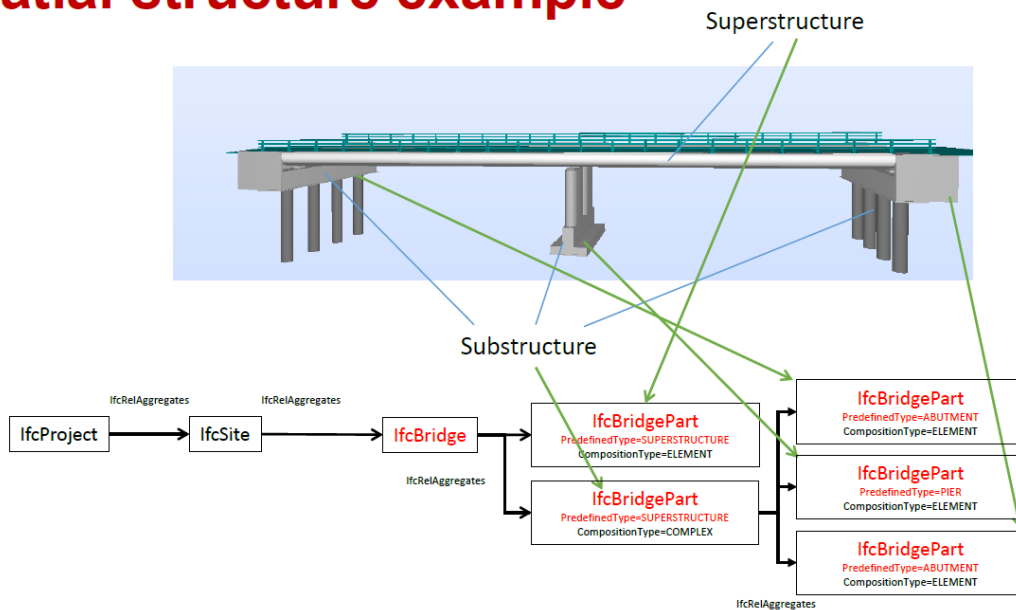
Bildhafte Darstellung Spatial structure mit Klassendarstellung (Hyvärinen 2018)
